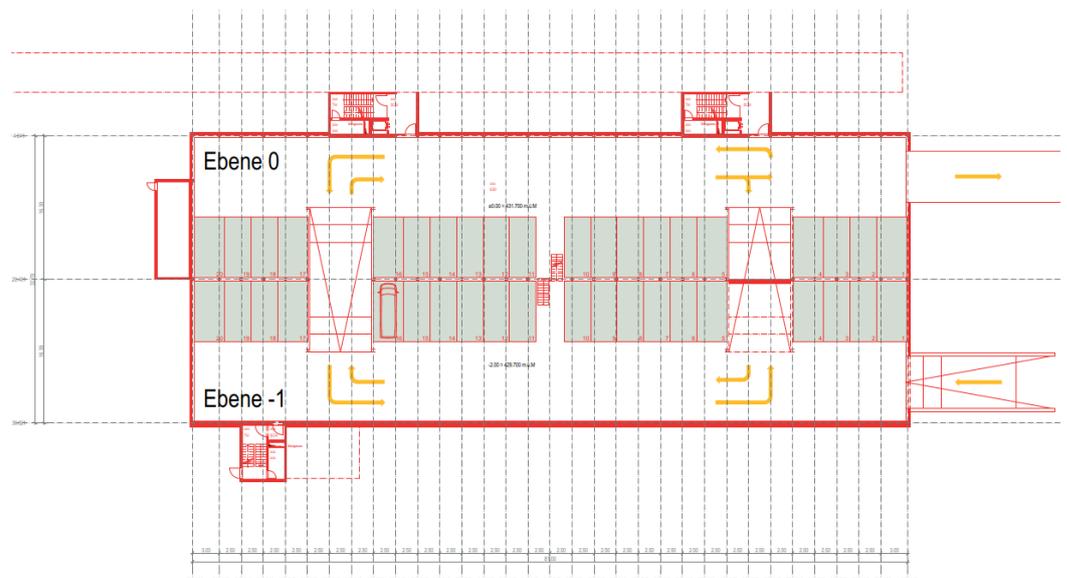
Grundriss Ebene Zustellfahrzeuge (Richtprojekt, ANS Architekten)
